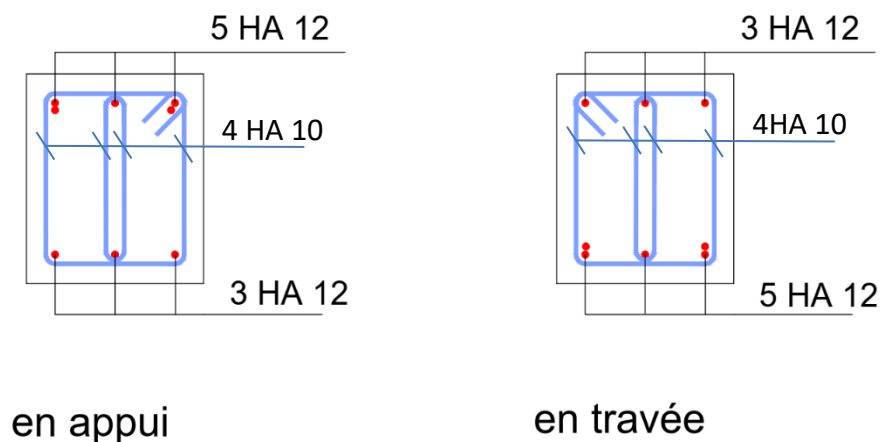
Schéma de ferrailage des poutres secondaires.
